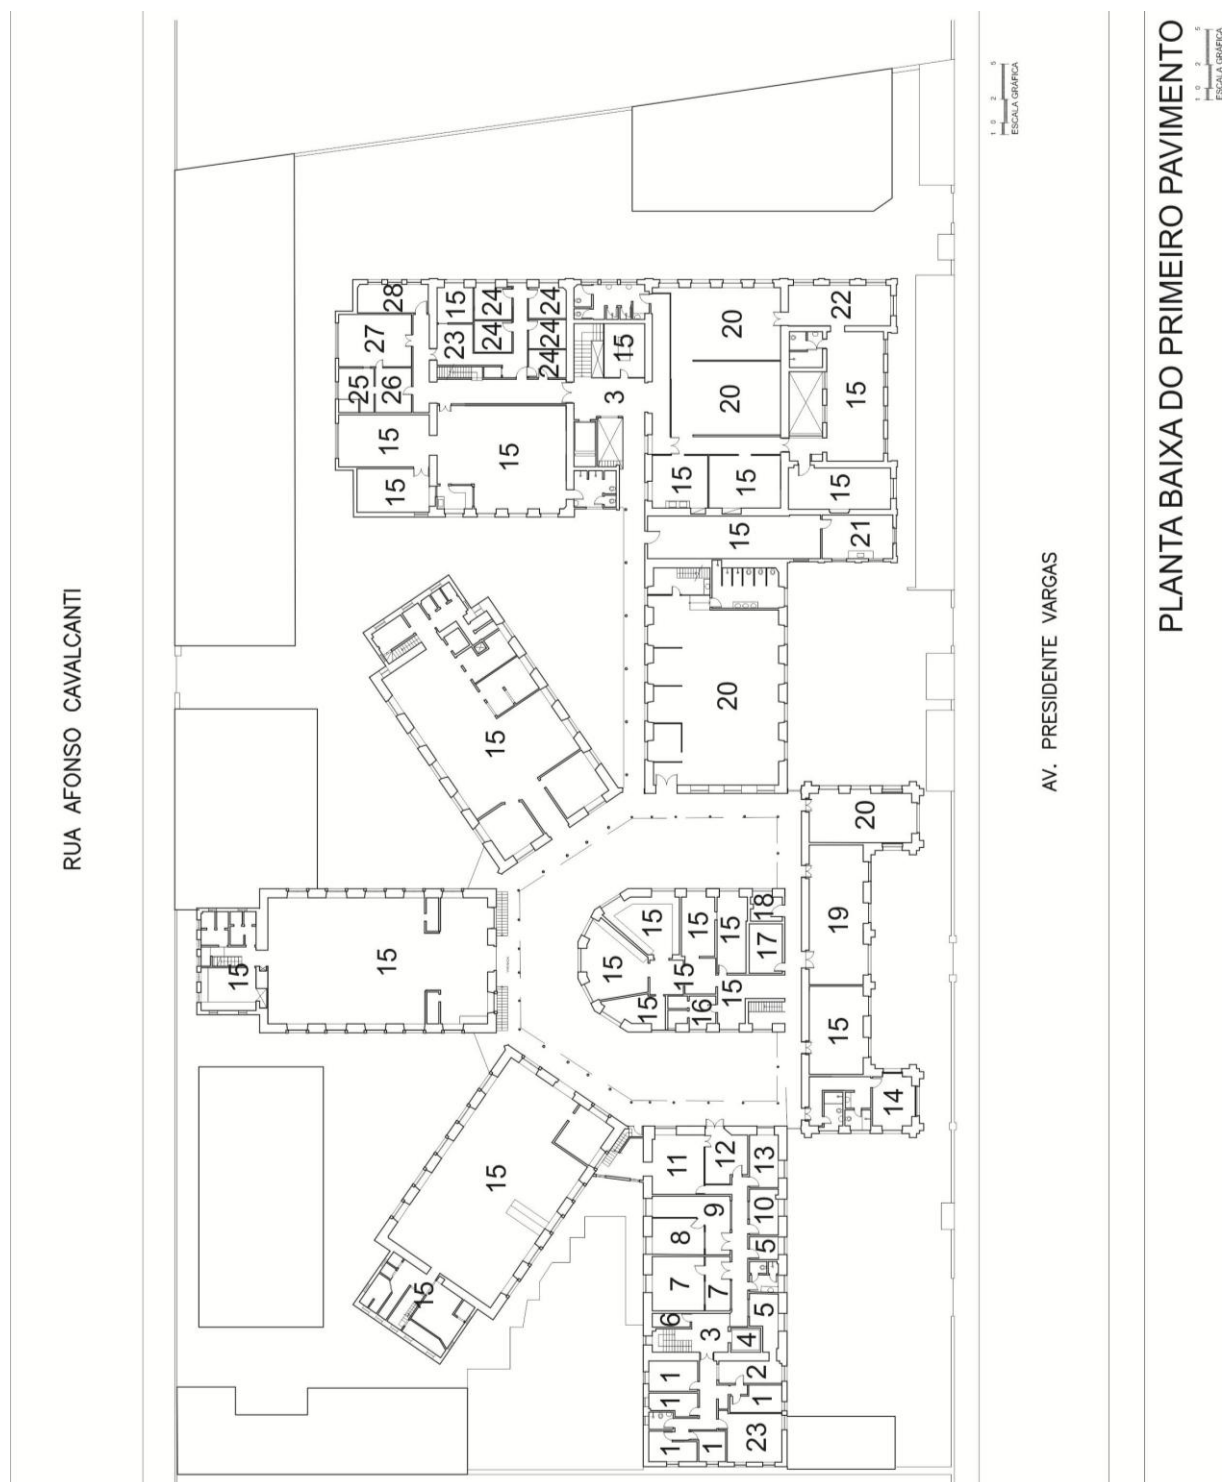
Planta Baixa do Primeiro Pavimento – Usos. Fonte: Plano Diretor, 2004.
